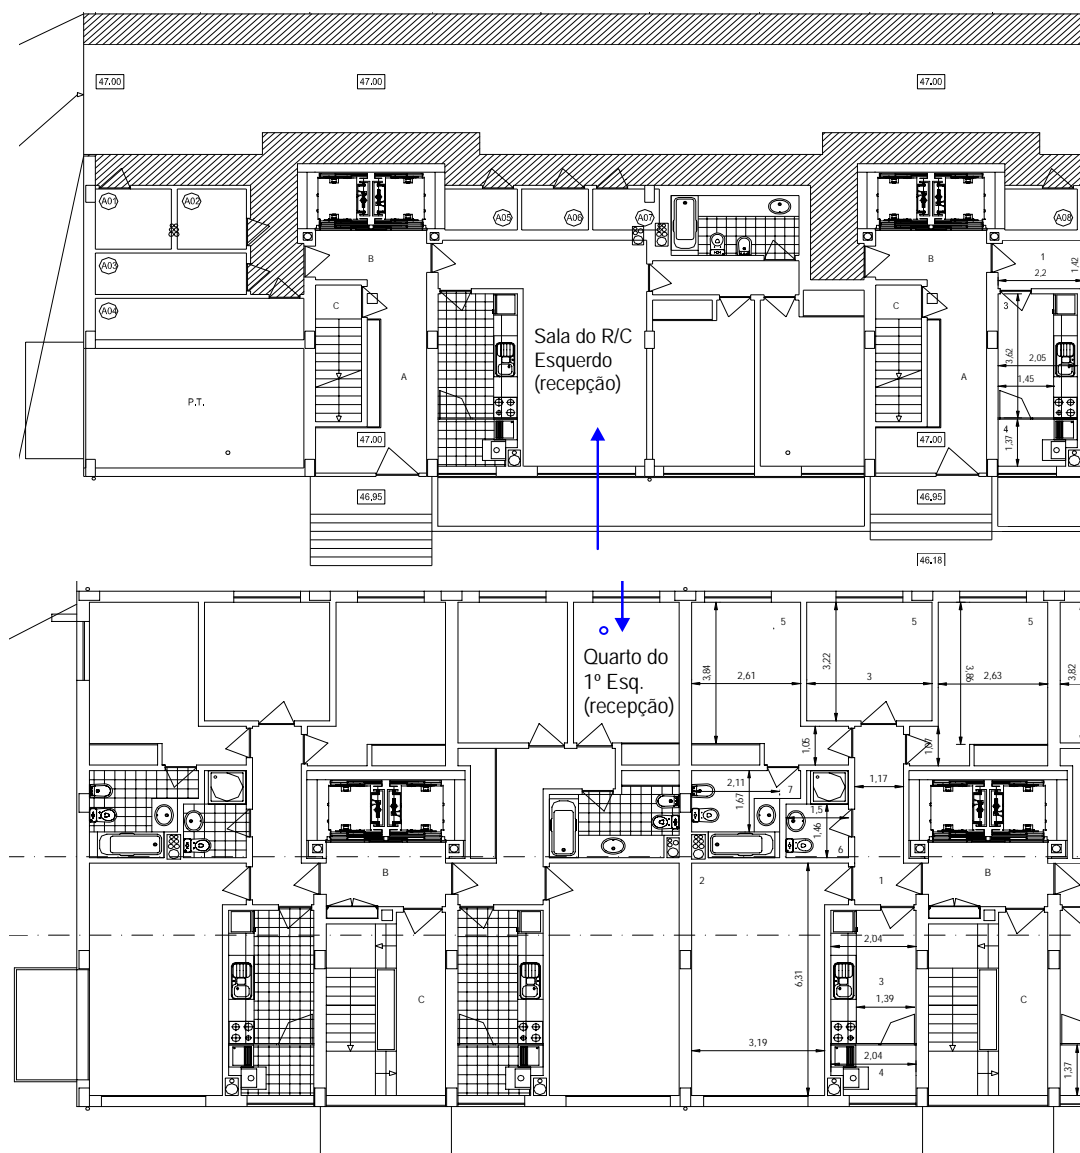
Planta dos recintos receptores dos ensaios de avaliação do isolamento da parede exterior 3, ParE4
